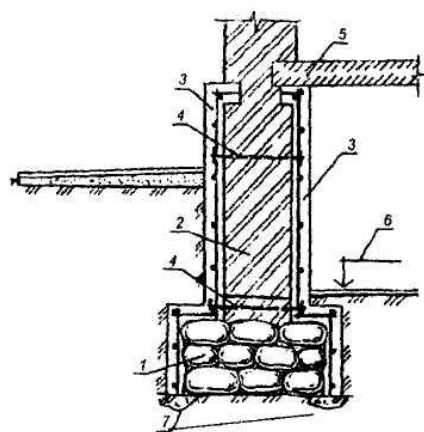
Устройство железобетонной обоймы для ленточного бутового или кирпичного фундамента
